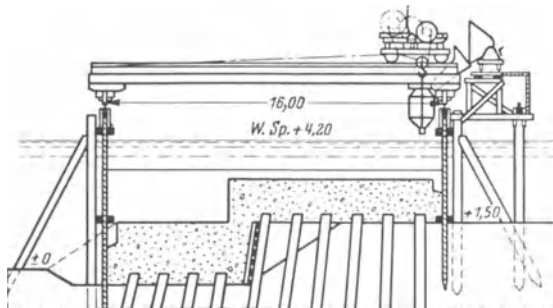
Herstellung von Unterwasserbeton: Einfüllen des Betons in mit Klappen unter Wasser zu öffnenden Kästen.
